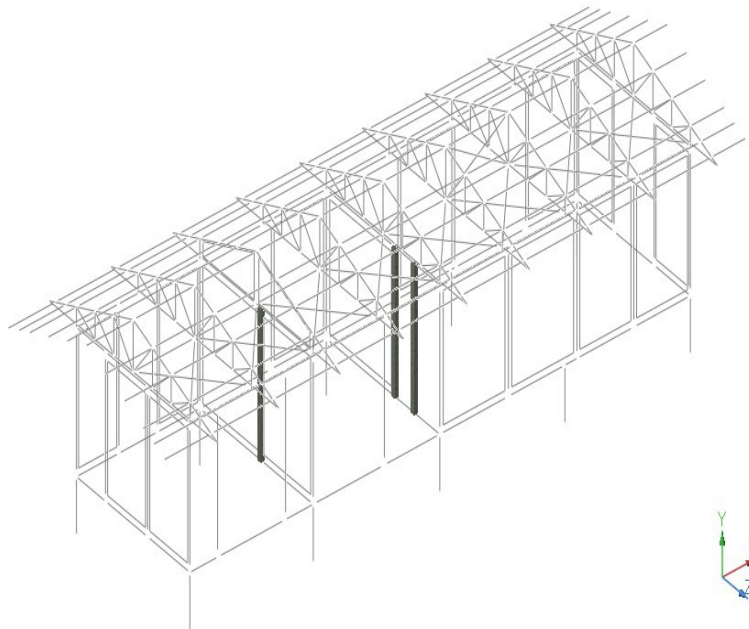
Ubicación de las columnas de encadenado tipo CE3.
